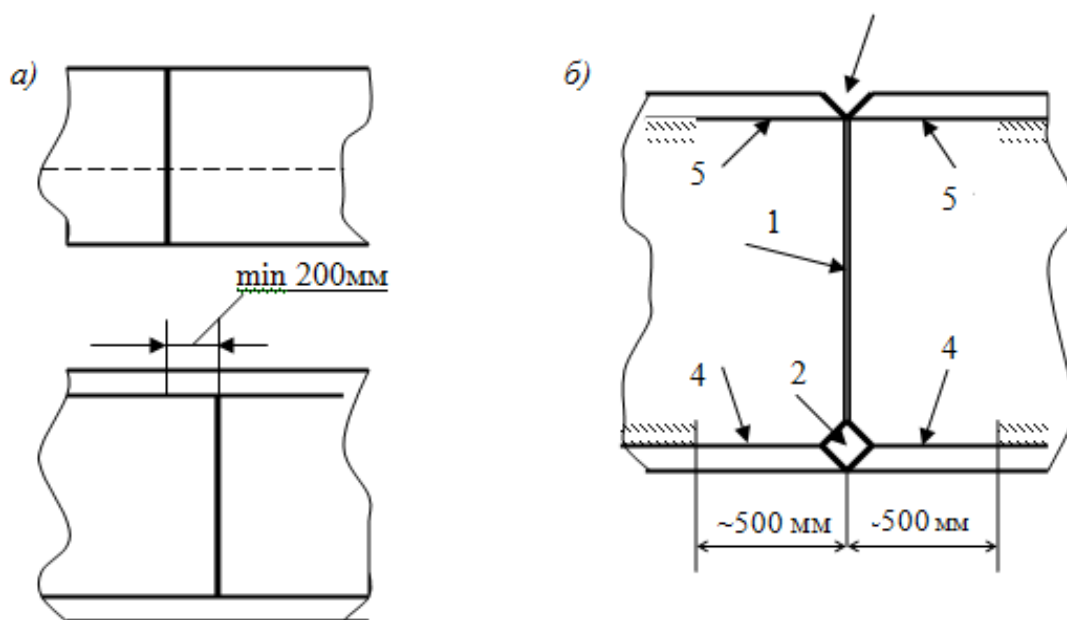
Стыки балок сварные: а – заводской; б - монтажный
